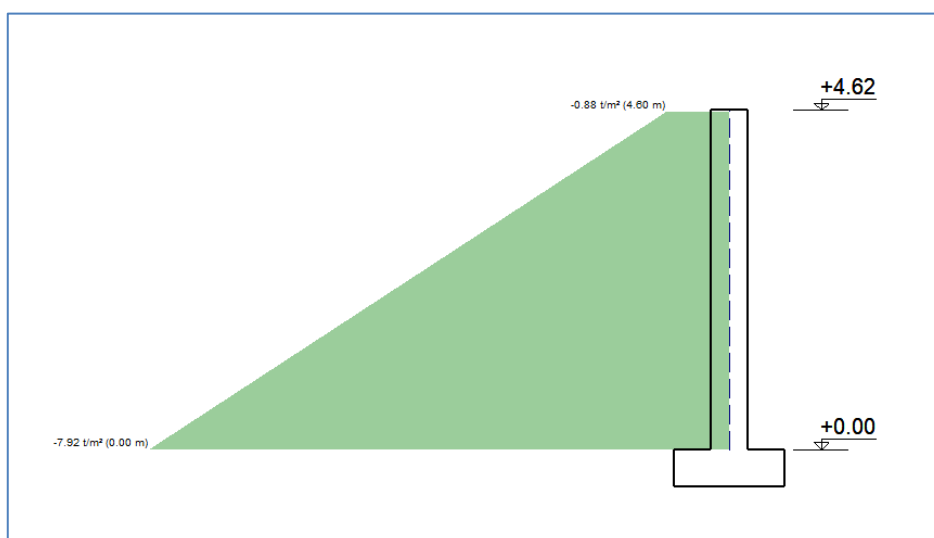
Lançamento dos carregamentos de empuxo nas paredes do modelo estrutural - Corte
